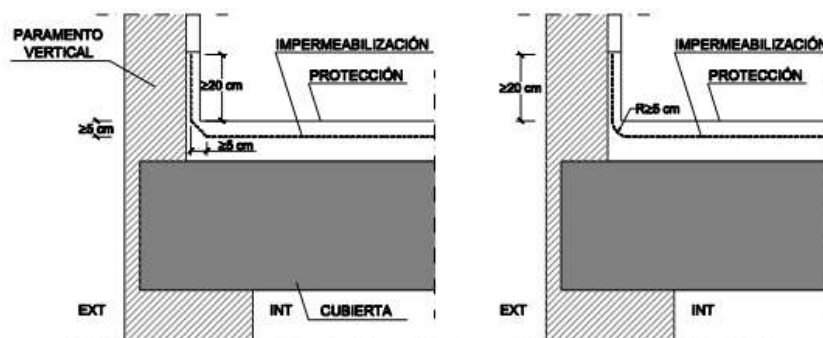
Encuentro de la cubierta con un paramento vertical
